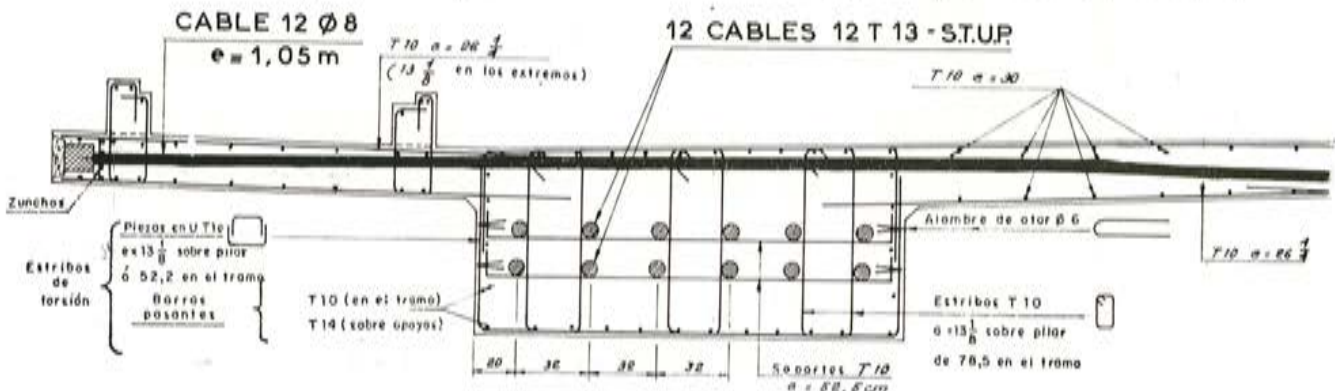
Armaduras y cables del puente de Herbitzheim.
